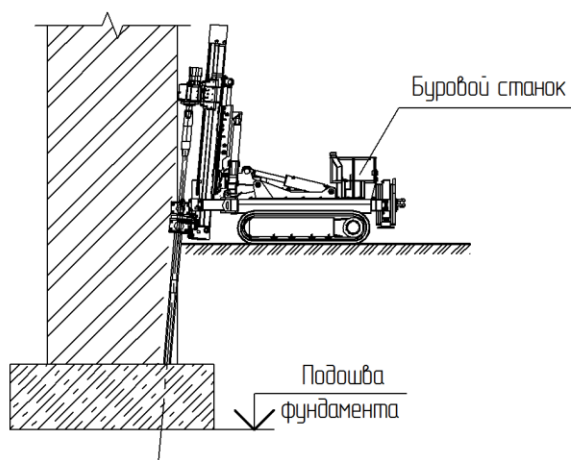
Схема крепления ограждения глубокого котлована анкерами Атлант
